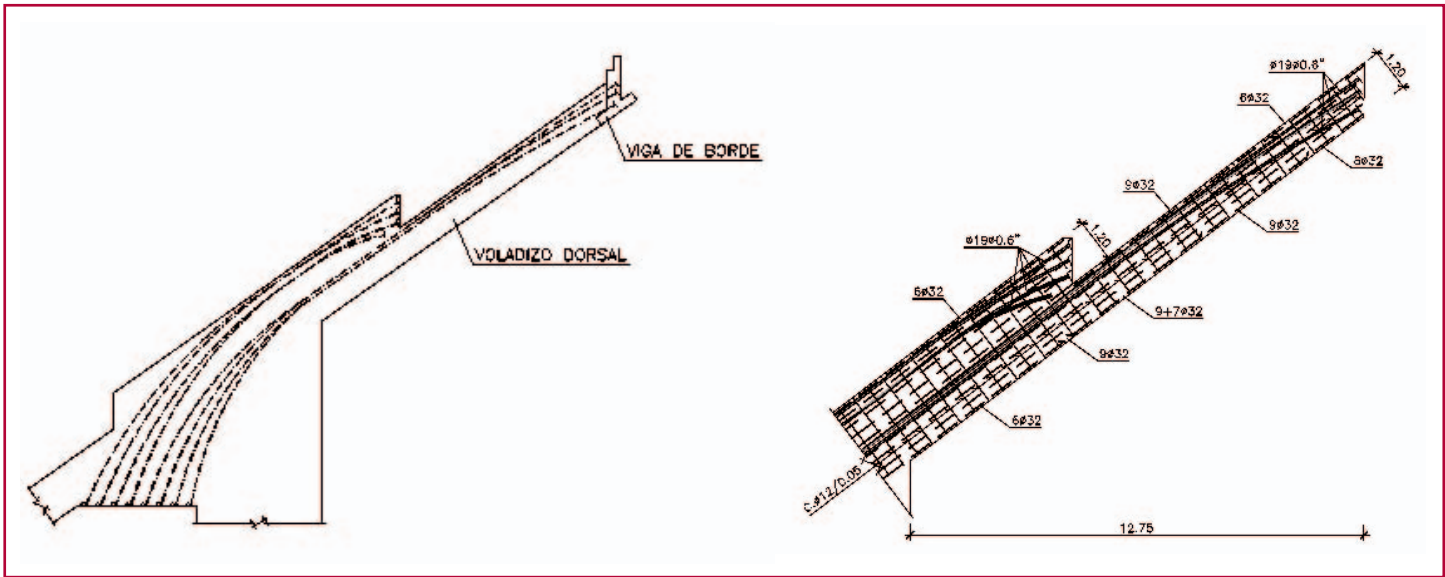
Geometría y distribución de armaduras activas y pasivas en las vigas en voladizo de los pórticos.
